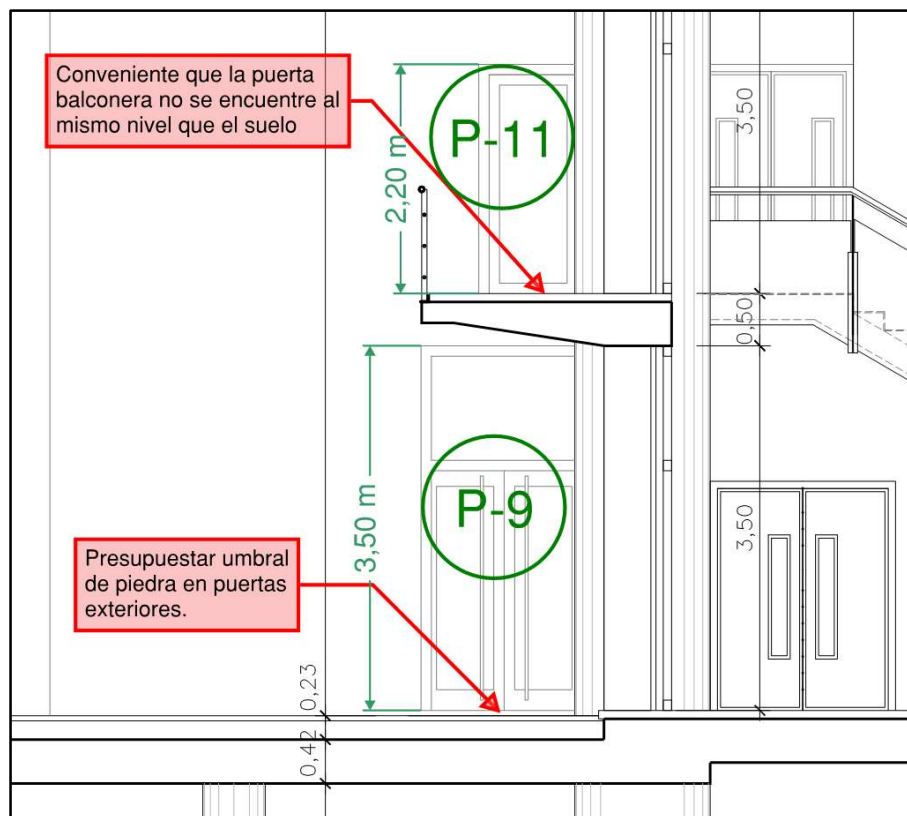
Barandilla con barrotes escalables. Detalle Sección C-C'
